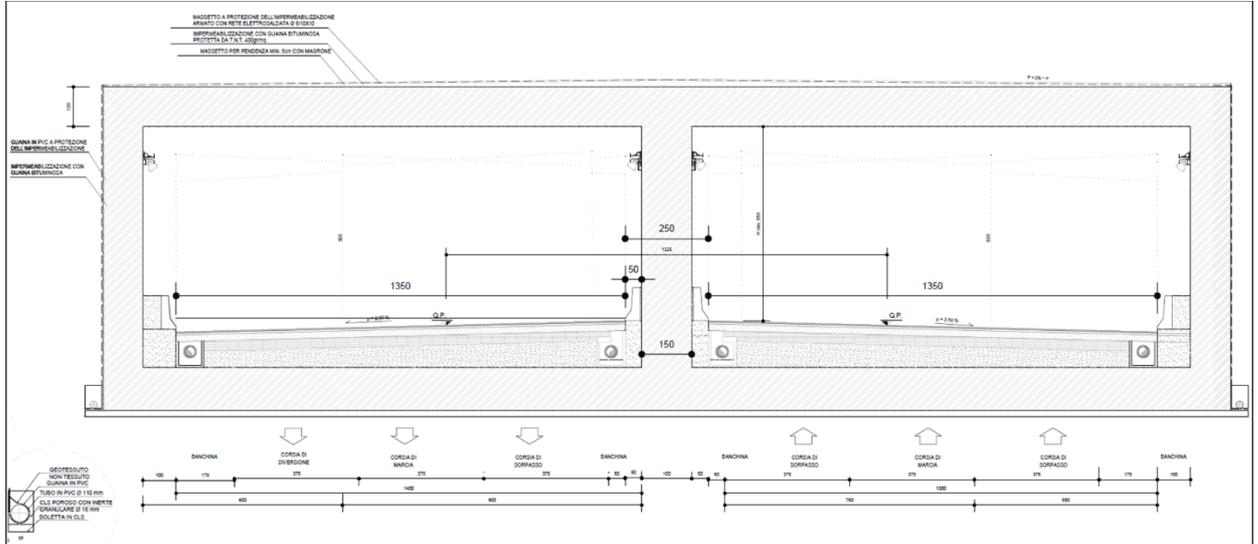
Sezione tipo longitudinale galleria artificiale attraversamento S.S. 1bis
